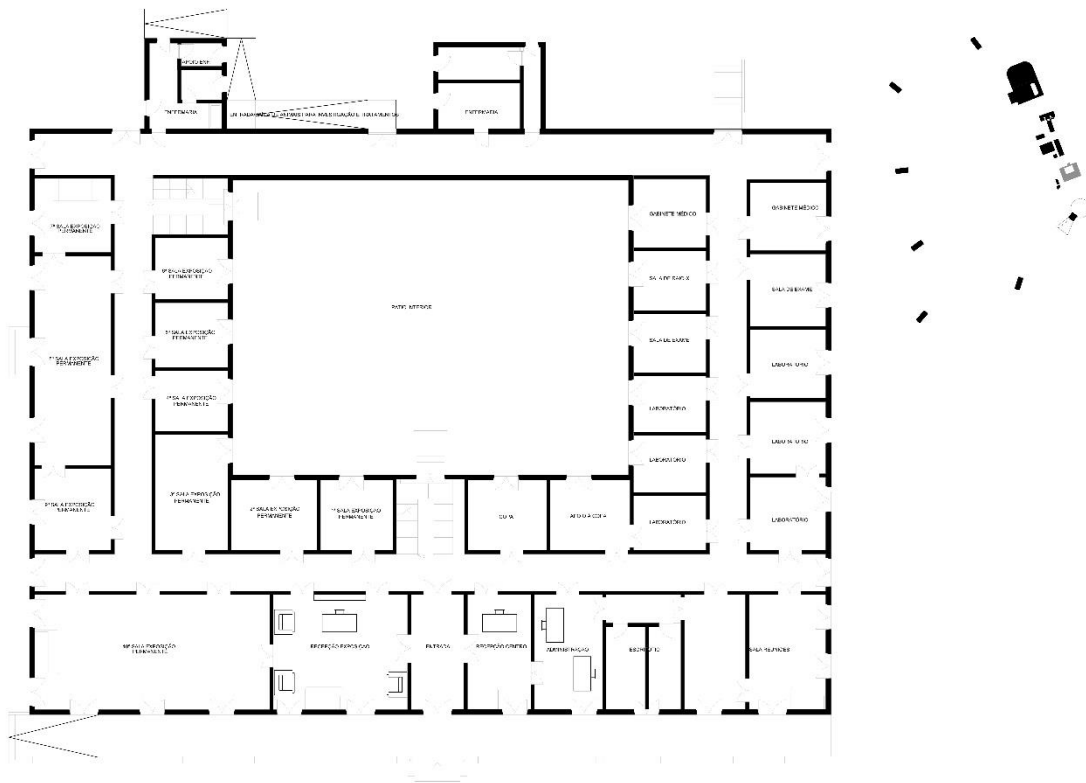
Planta do Palácio do Vidigal - Piso 1
